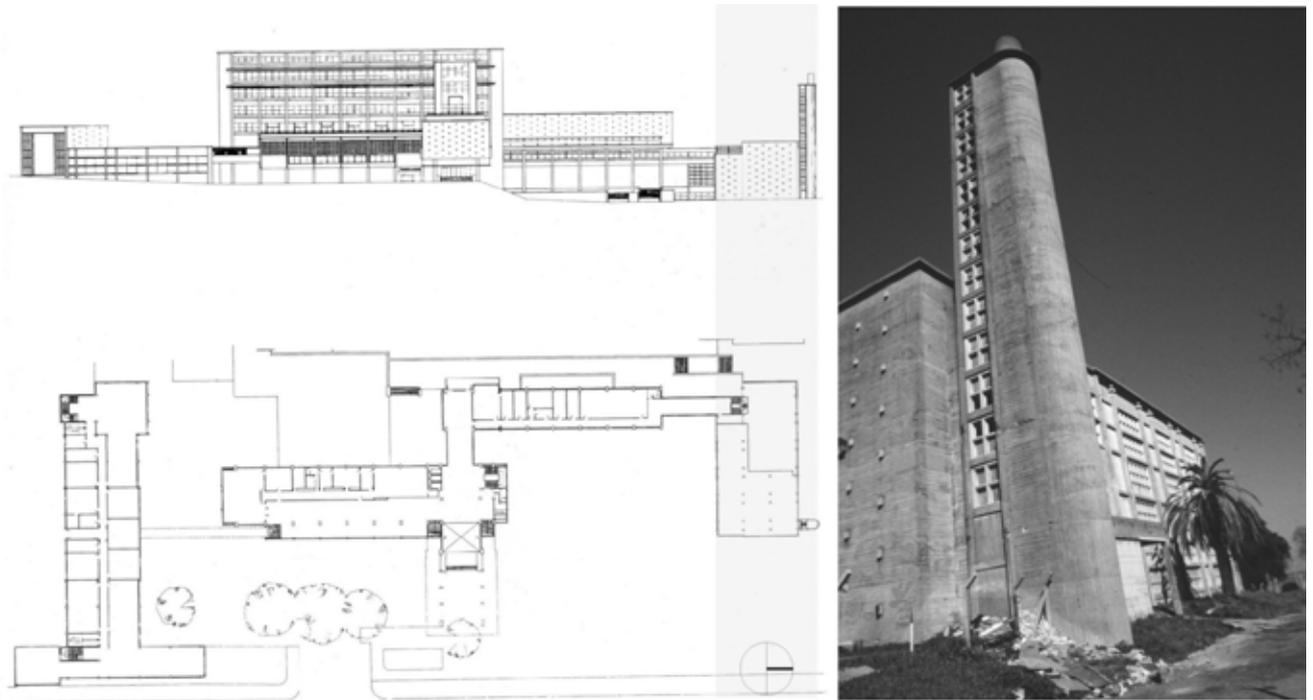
| Foto, planta y fachada de la preexistencia.
